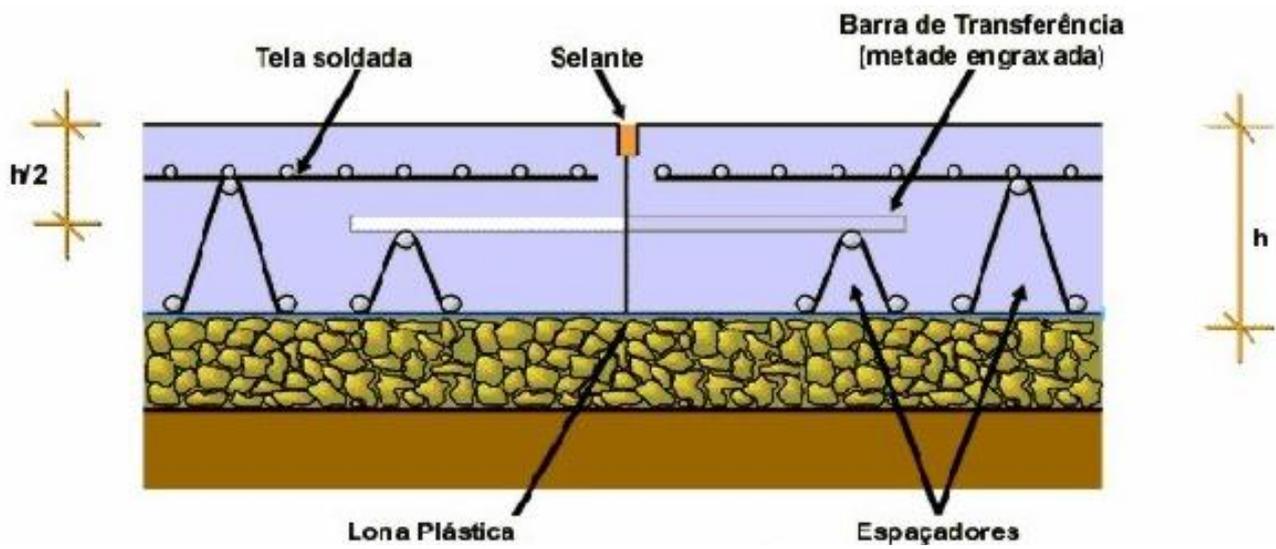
Piso de concreto – corte esquemático da estrutura
